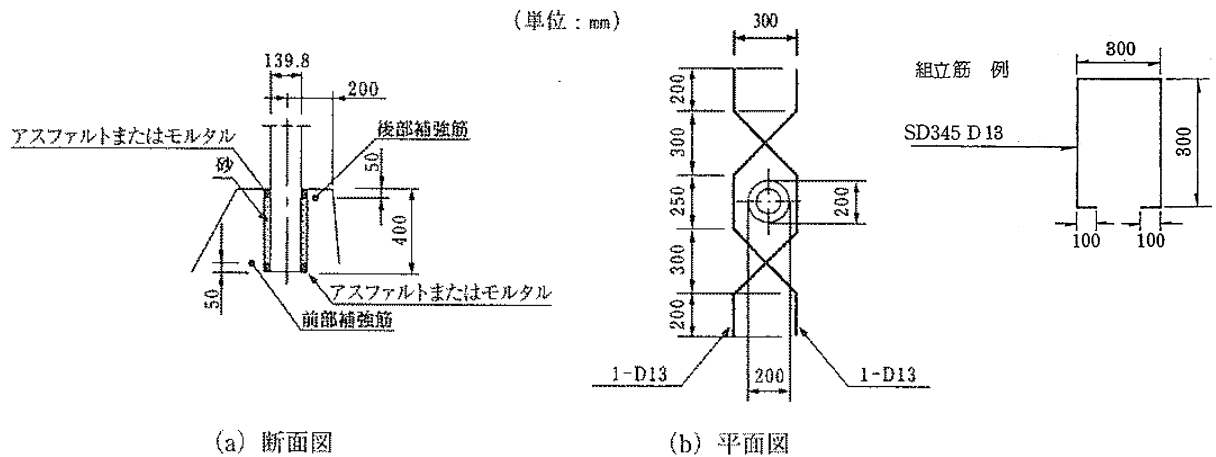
III-37 防護柵(ガードレール)基礎の補強筋配置例
